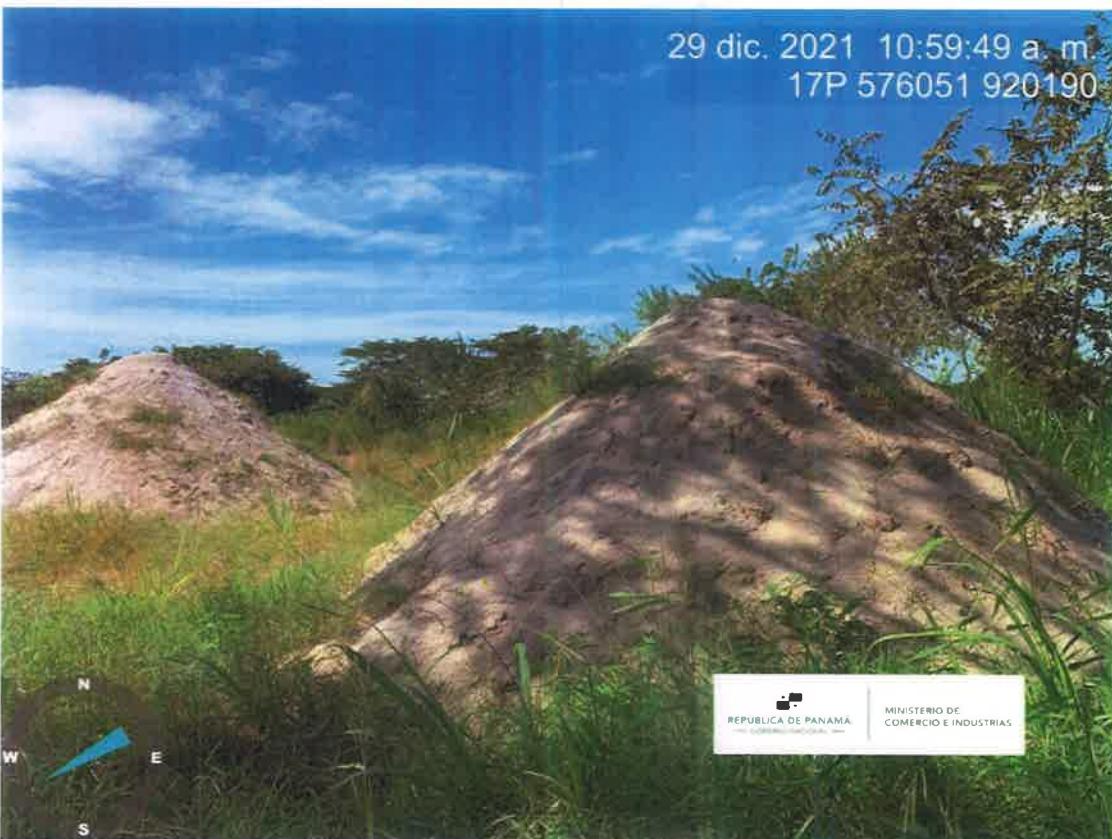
Material (arena continental) acumulado producto del dragado del abrevadero existente.
